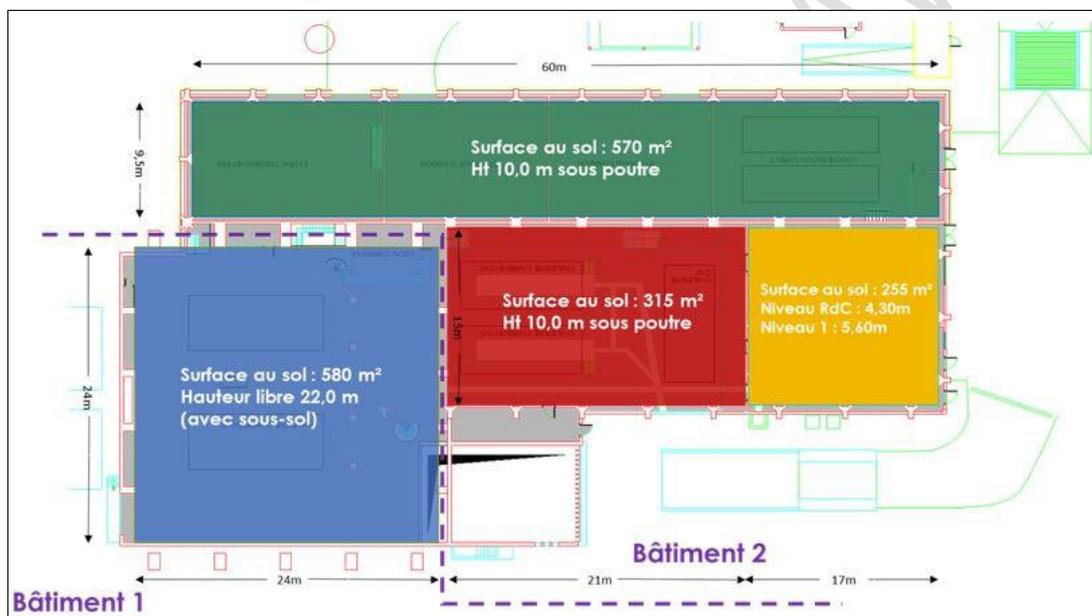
Plan du rez-de-chaussée de la chaufferie de l'INSA
